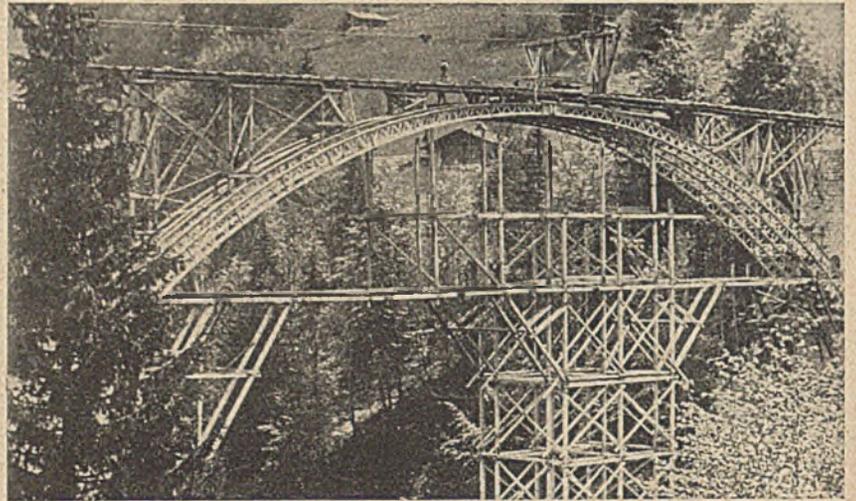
Brücke über die Grande Eau bei Les Planches. Eisernen Gitterbogen aufgestellt, Montagegerüst im Abbruch.
